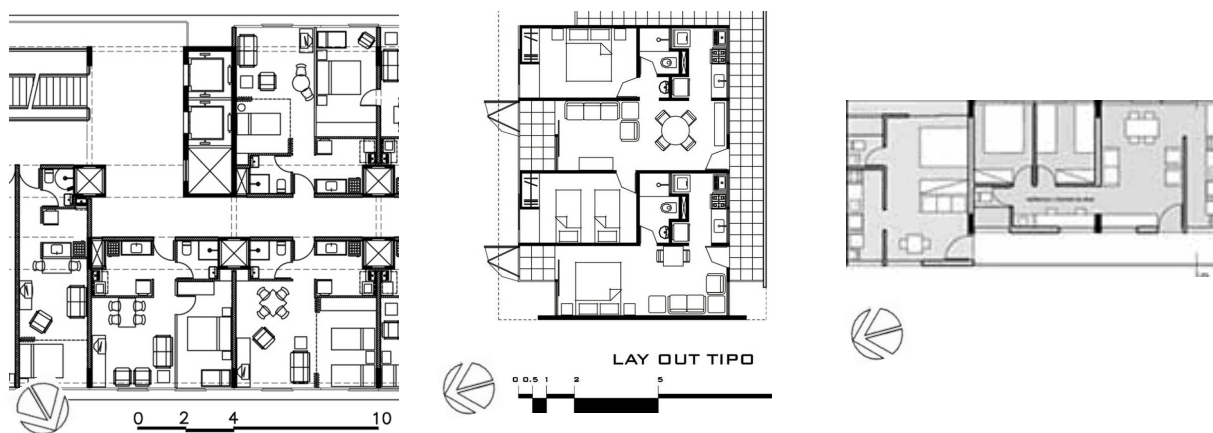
Trecho da planta tipo do projeto Habitasampa Assembléia (VA-04). Trecho da planta tipo do projeto CAIXA-IAB (VA-03). Trecho da planta tipo do projeto CAIXA-IAB (VA-01).
